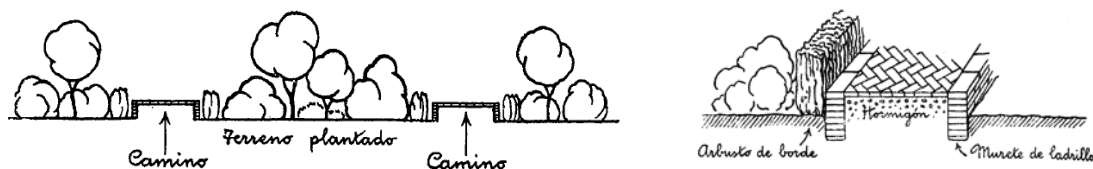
> Esquema de la sección de los caminos elevados construidos para garantizar la escorrentía del agua hacia el terreno plantado (Rubí i Tudurí 1934, p.242 i 244)
